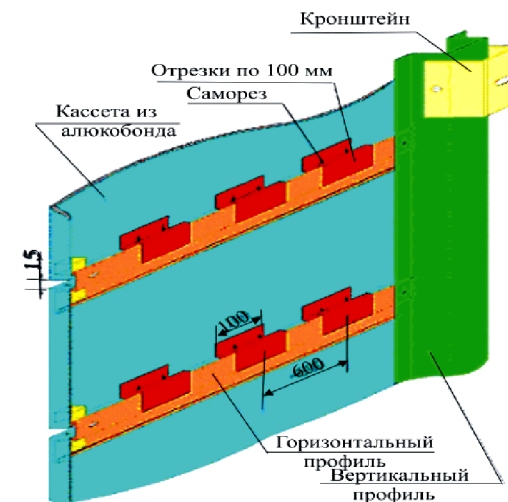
Схема подвесной фасадной системы Алюкобонд (вид изнутри)
